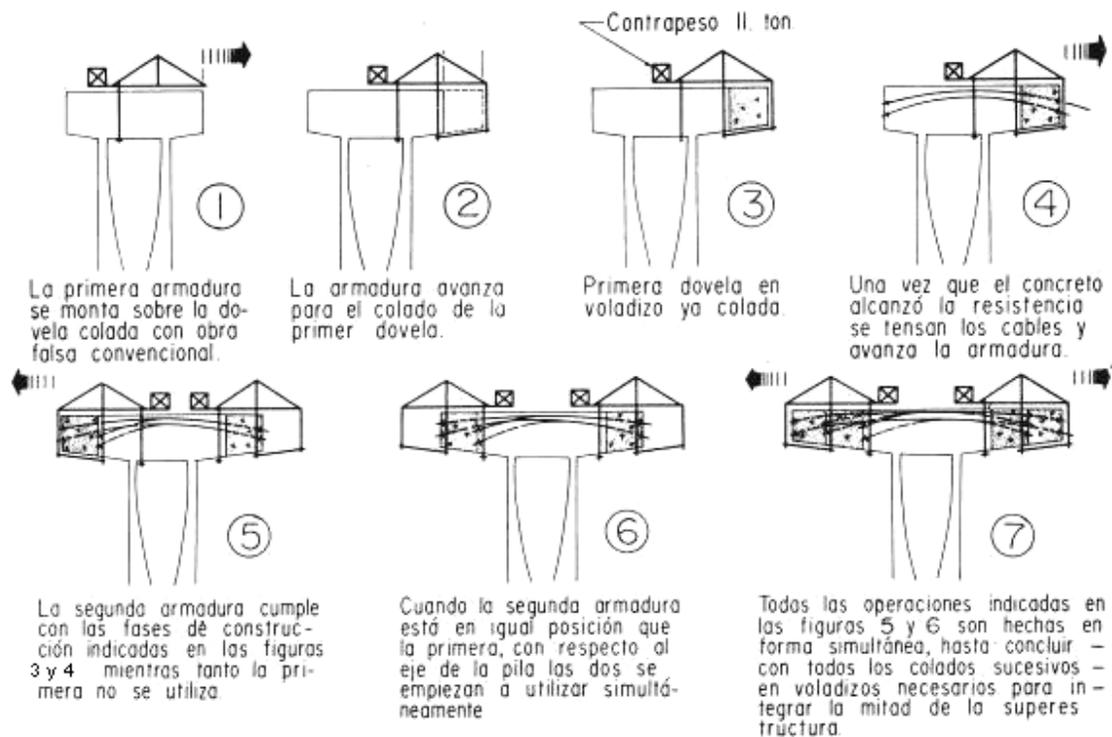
Secuencia de construcción de puentes en doble voladizo.
